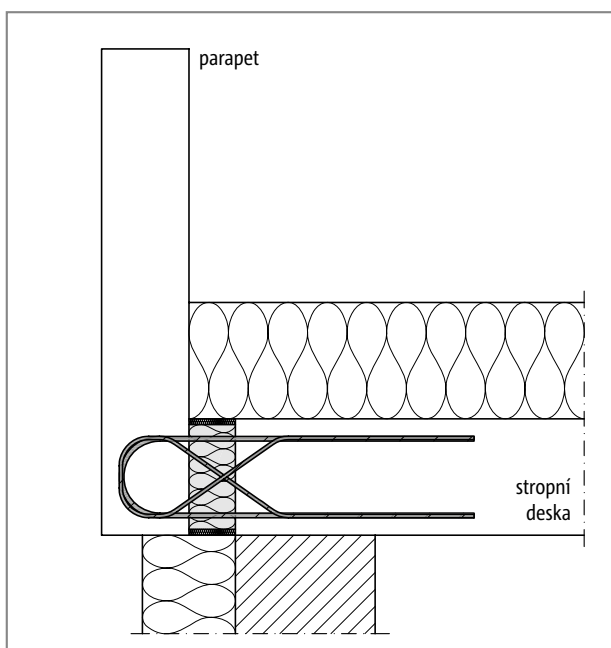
Schöck Isokorb® T typ AP - svislé zabudování: Pohled, uložení parapetu resp. atiky na stropní desce
